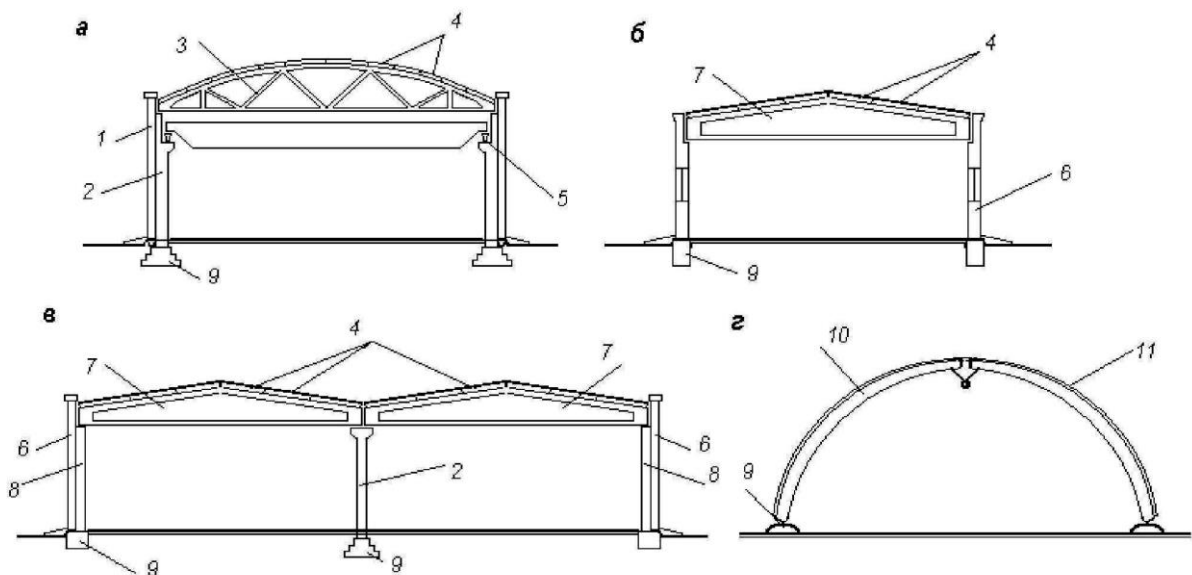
Конструктивні типи одноповерхових виробничих будівель: а – каркасний; б – безкаркасний; в – з неповним каркасом; г – шатровий;
